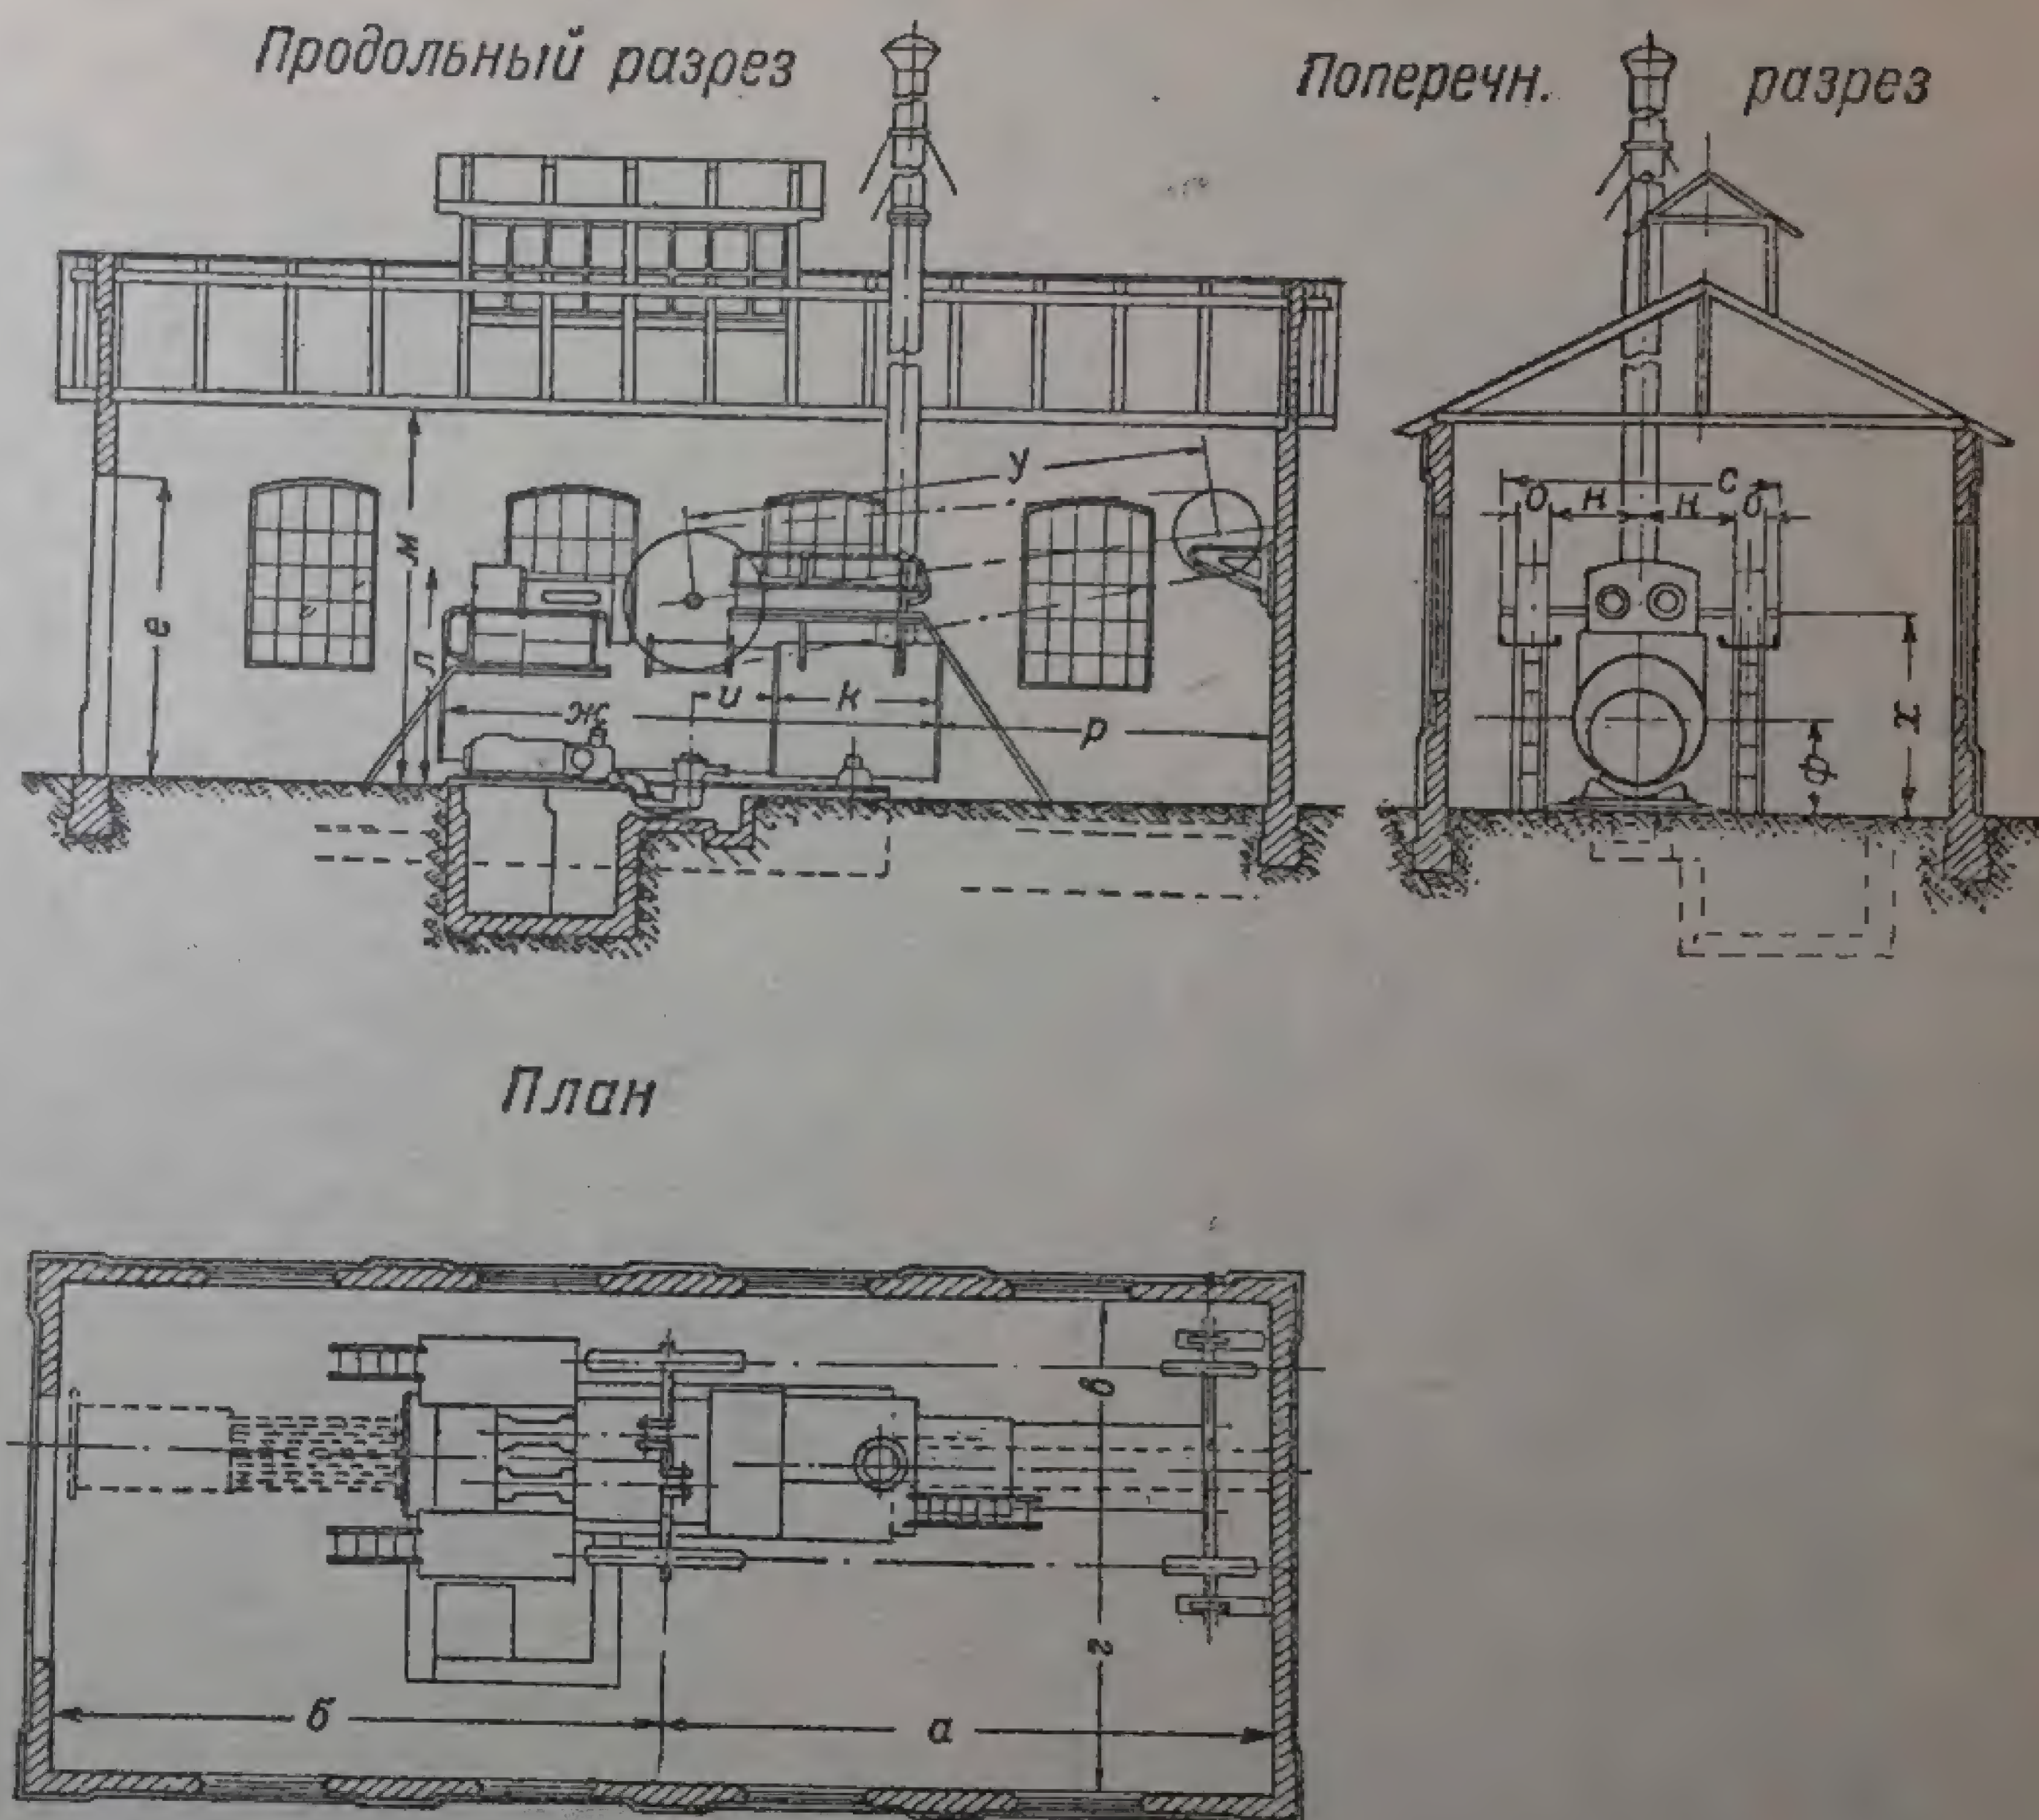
Монтажный чертеж для установки локомотива класса ЛМ Людиновского завода
